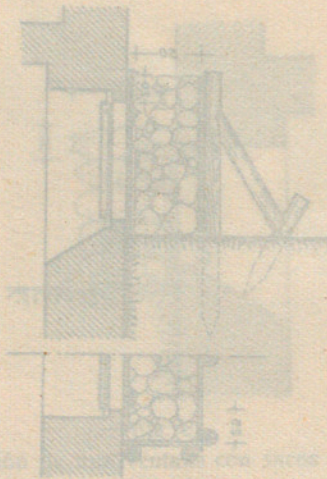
Protección de la ventana de un sótano con piezas encajadas entre tablas. Sección longitudinal.
